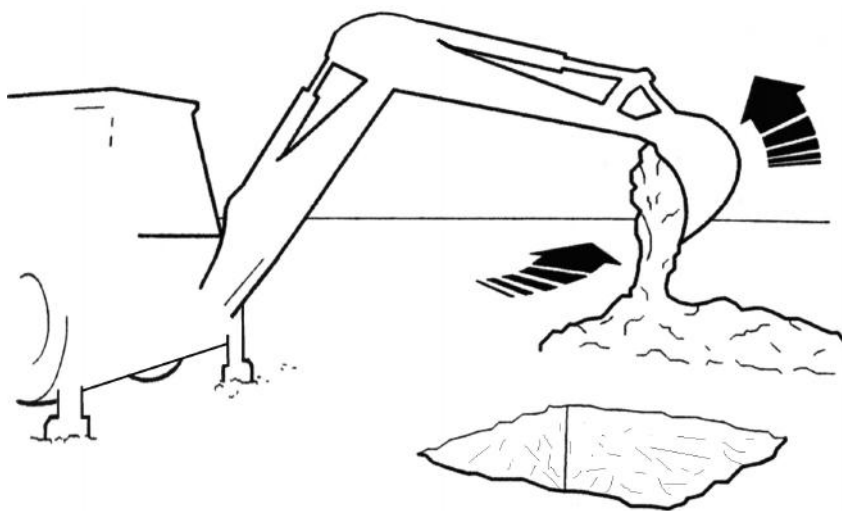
Разгрузка ковша экскаваторного оборудования
